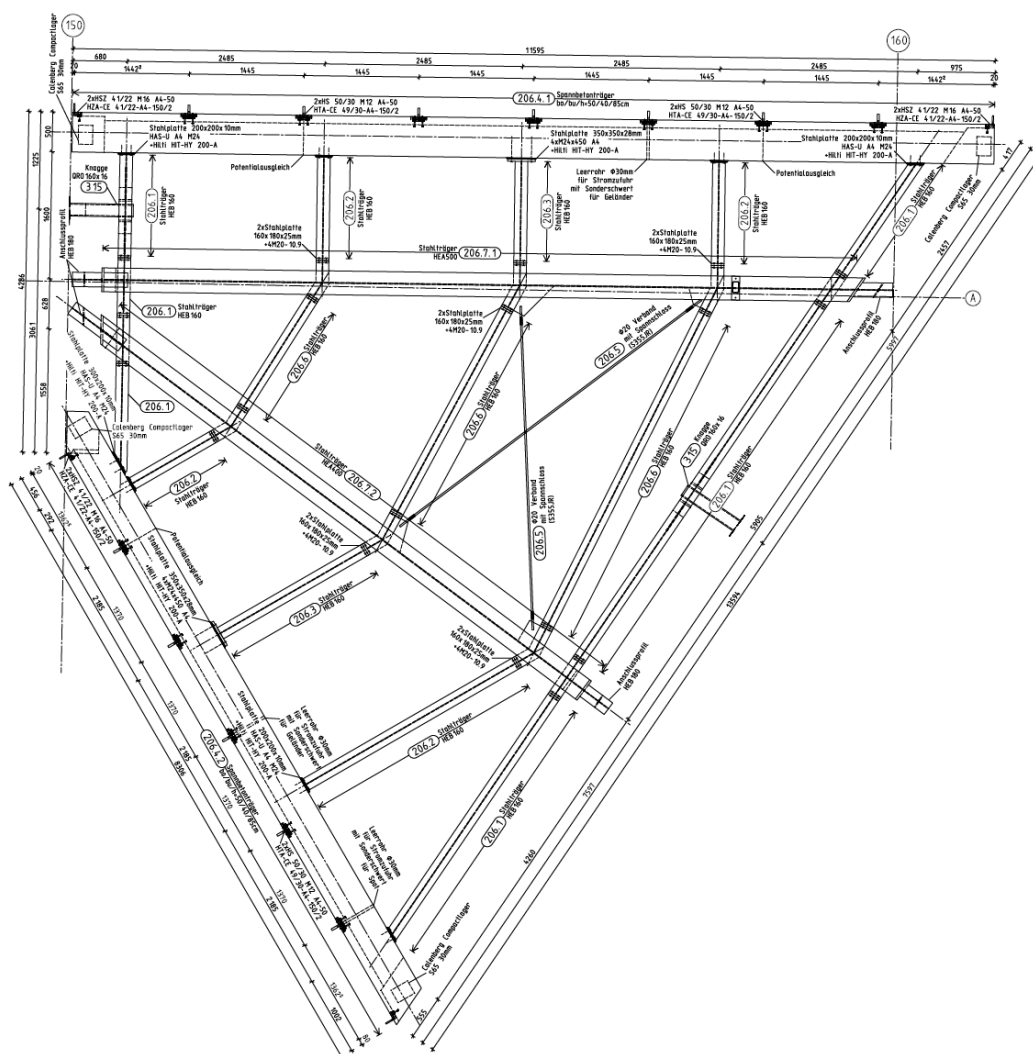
Überbau: Trägerrost mit Stahllängsträgern
